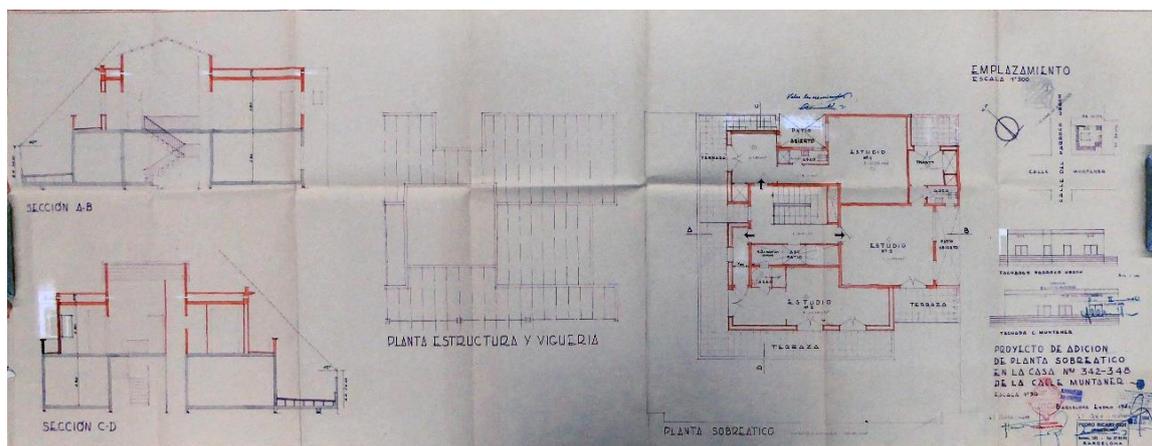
Planos del arquitecto Pedro Ricart Biot para la ampliación de sobreático en Muntaner 342-348. Arxiu Contemporaneo de Barcelona. Carpeta 86961. Plano sin numerar.
